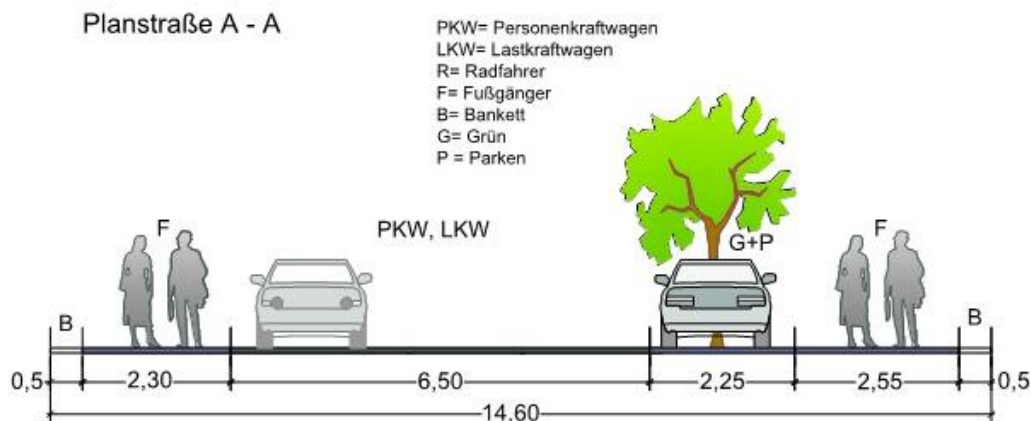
Straßenquerschnitt der Planstraße A, ohne Maßstab
